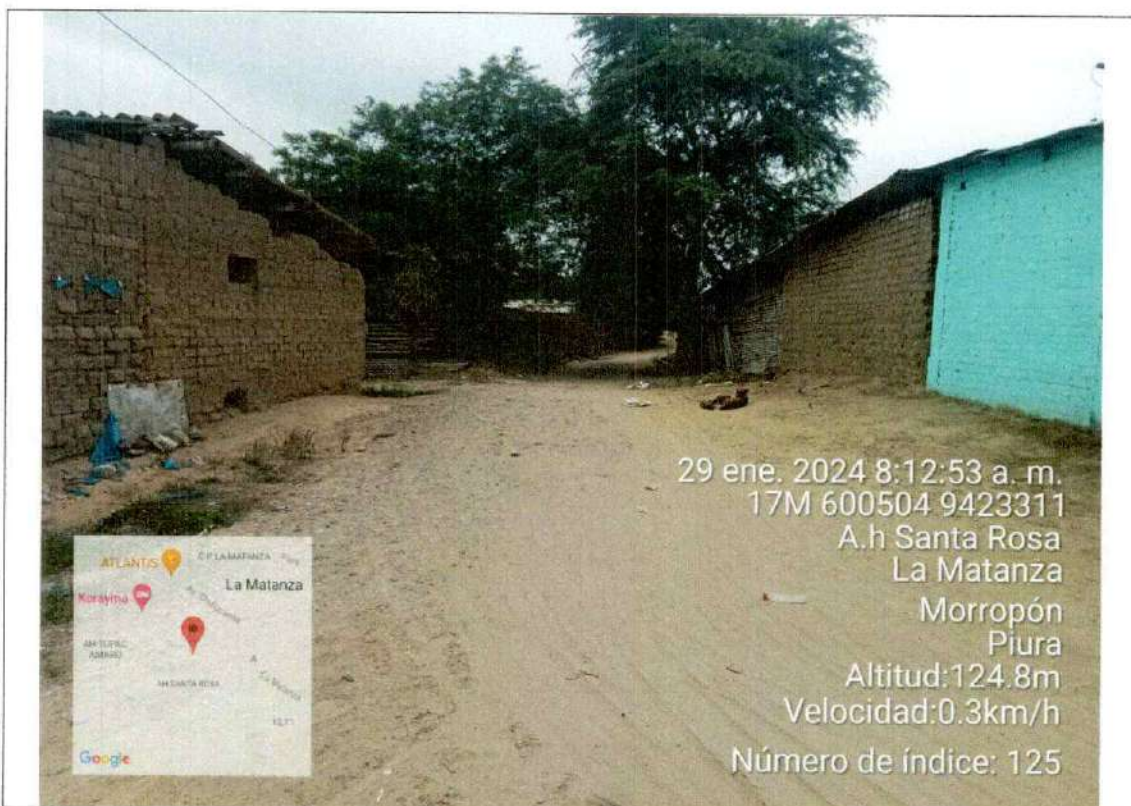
Vista de la calle 03 del A.H. Santa Rosa
